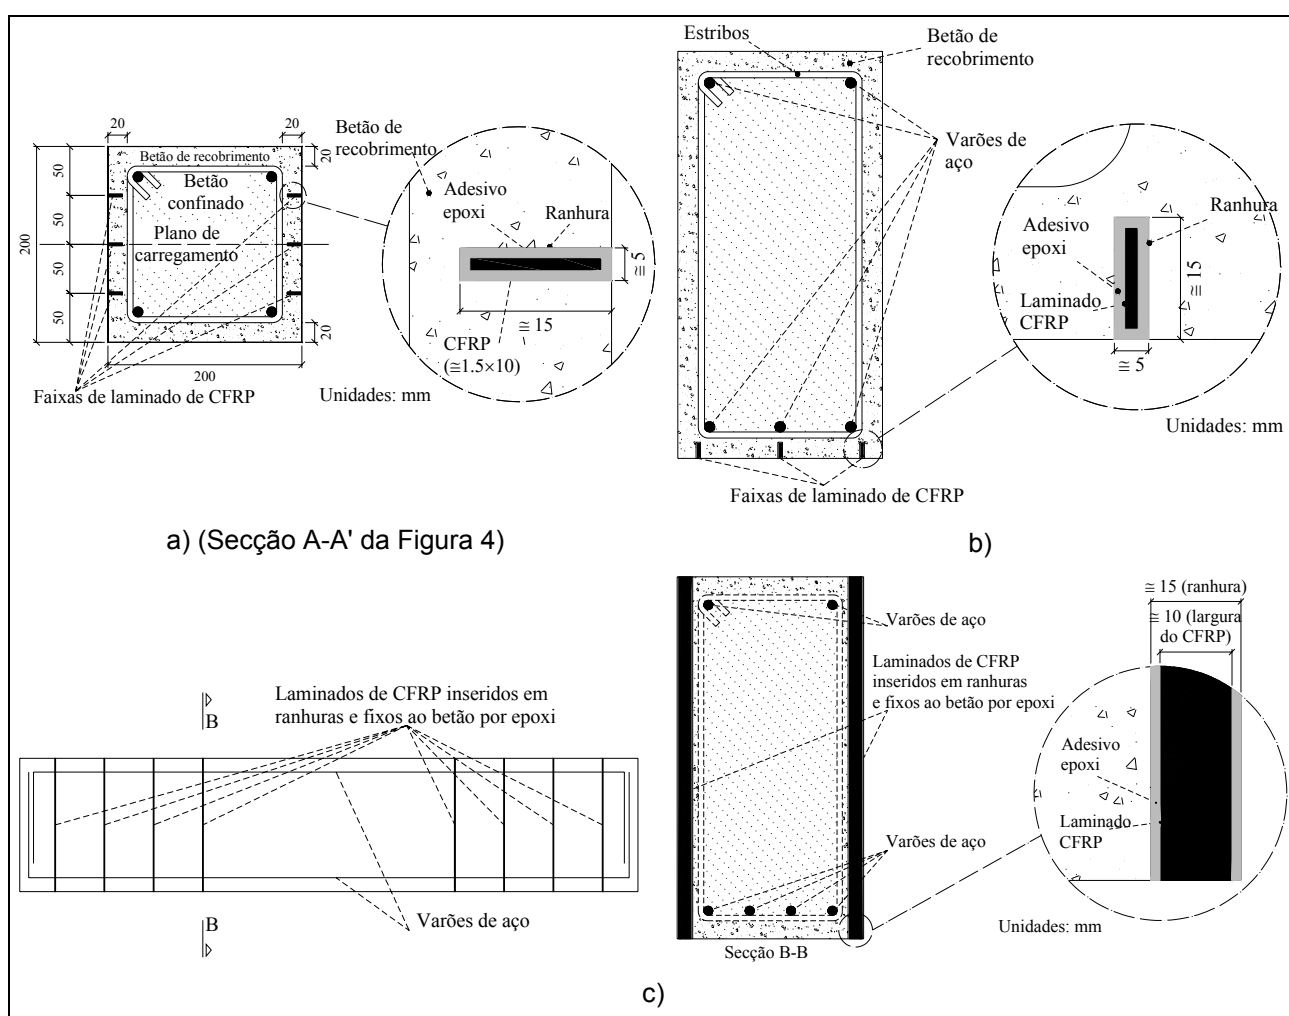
Técnica de reforço aplicada a: a) pilares que rompem por flexão; b) vigas que rompem por flexão; c) vigas que rompem por corte.
